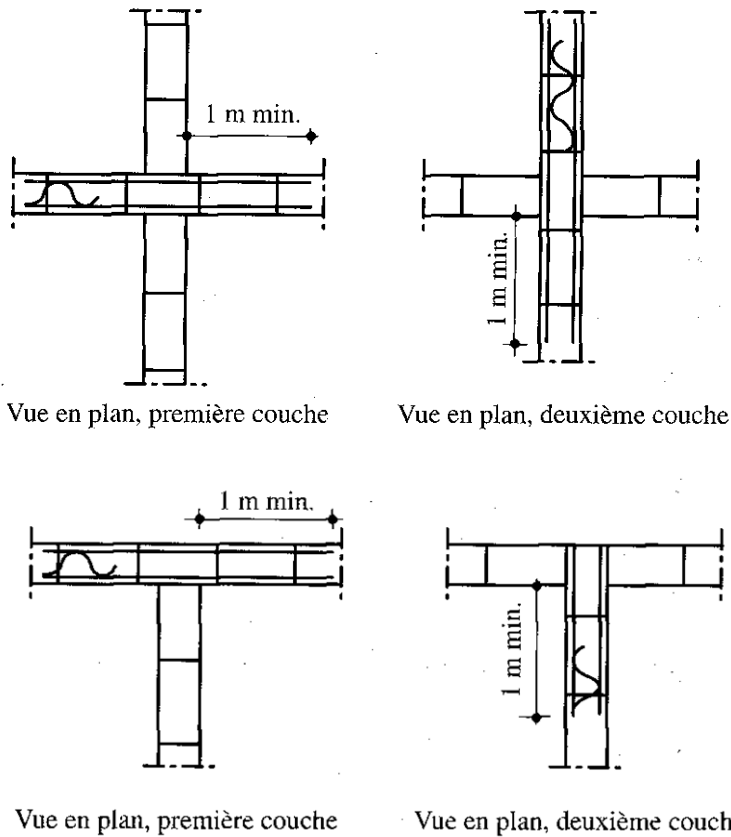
Jonction de 2 murs en matériaux non sciés. Armatures dans les joints d'assise. (NBN ENV 1996-1-1 NAD, 2002)
